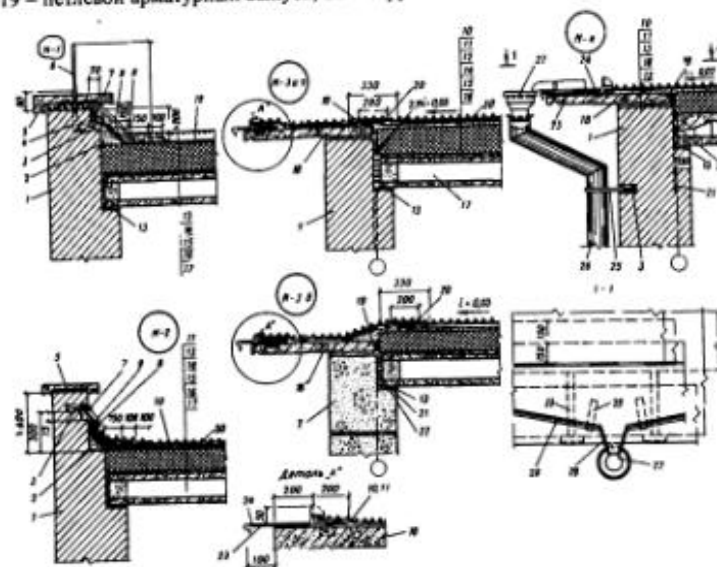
Бесчердачная вентилируемая крыша типа "М": Узлы М-1 М-4; 1 – стена кирпичной кладки; 2 – цементно-песчаный раствор; 3 – антисептированная деревянная пробка; 4 – трубчатый анкер ограждения, заделанный в кладку; 5 – парапетная плита; 6 – ограждение; 7 – антисептированная деревянная рейка 40x75 мм; 8 – фартук из кровельной оцинкованной стали; 9 – два дополнительных слоя рубероида; 10 – слой бронированного рубероида на битумной мастике; 11 – два слоя прокладочного рубероида на битумной мастике; 12 – мастичная гидроизоляция, армированная стеклотканью; 13 – цементно-песчаная стяжка; 14 – плитный утеплитель; 15 – слой керамзитового гравия по уклону; 16 – слой прокладочного рубероида; 17 – многослойная панель; 18 – карнизная плита; 19 – закладная деталь; 20 – две дополнительные полосы рубероида; 21 – стальной анкер, заделанный в кладке; 22 – утепляющий вкладыш; 23 – кровельный костыль; 24 – кровельная оцинкованная сталь; 25 – крюк крепления водосточной трубы; 26 – водосточная труба; 27 – приемная воронка водосточной трубы; 28 – лоток из кровельной оцинкованной стали; 29 – желоб; 30 – слой гравия, втопленного в мастике
